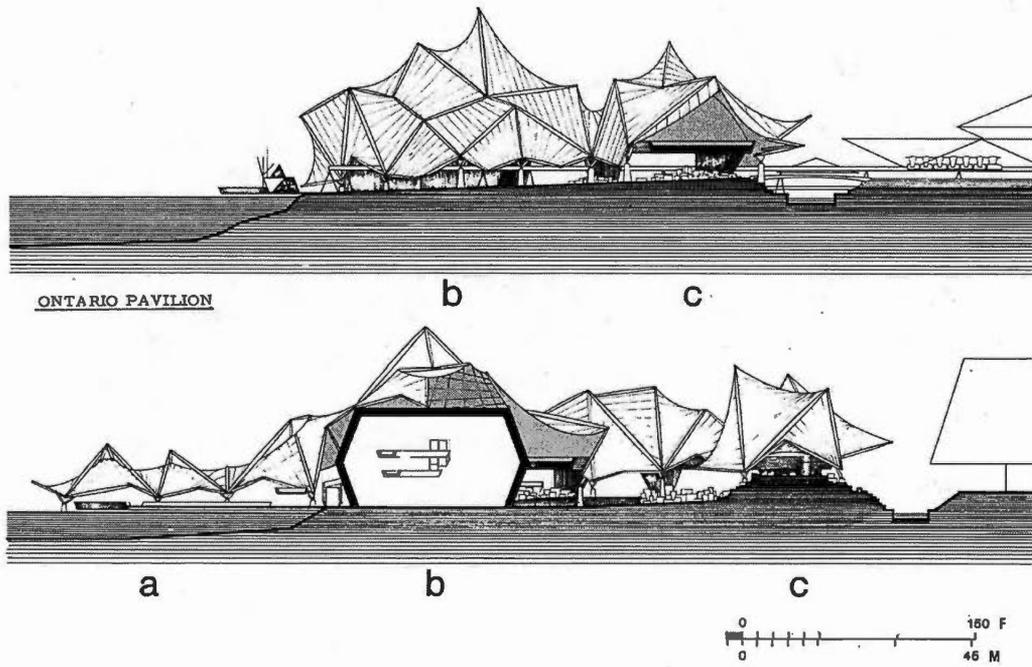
Élévation et coupe du pavillon de l'Ontario
